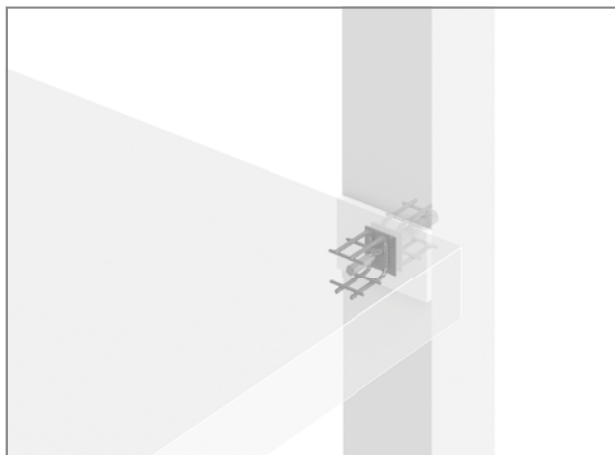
Schöck Dorn: raccordo soletta-pilastro
